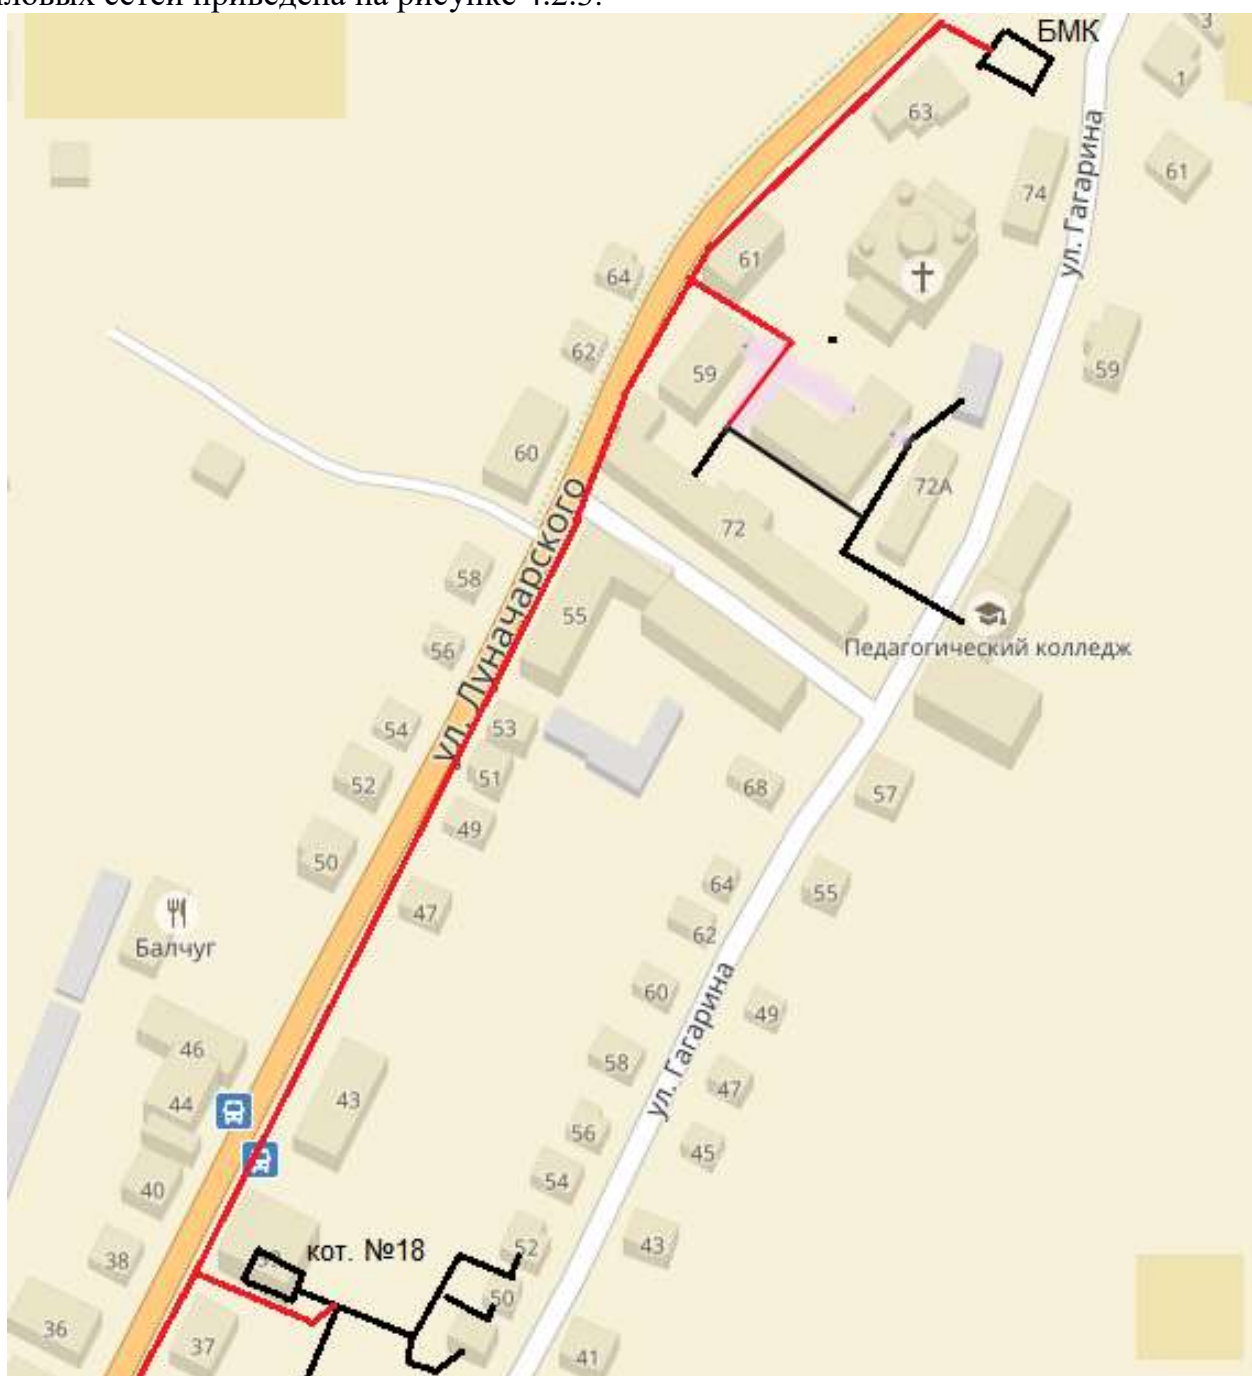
Схема прокладки соединительного участка теплосети БМК – котельная №20 – котельная №18
